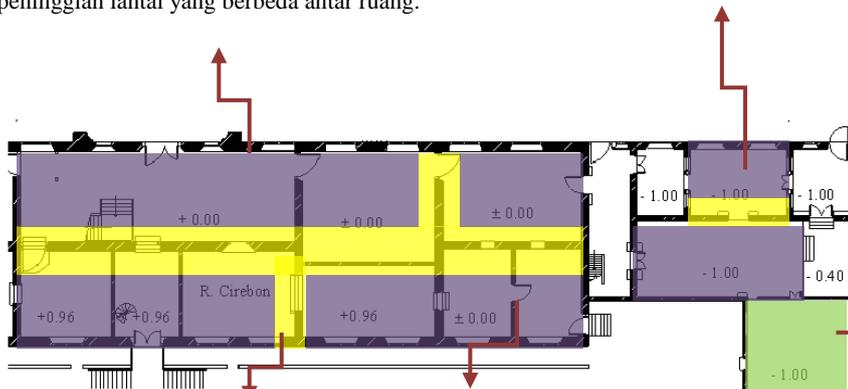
Ruang yang bersebelahan pada denah lantai 1-b Museum Fatahillah
